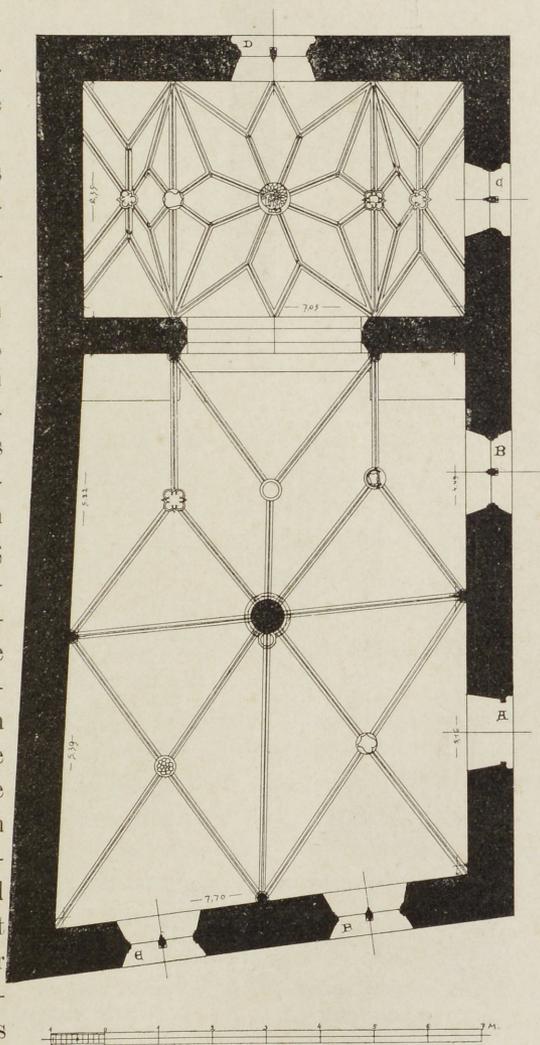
Kerpen. Grundriss der Schlosskirche.
